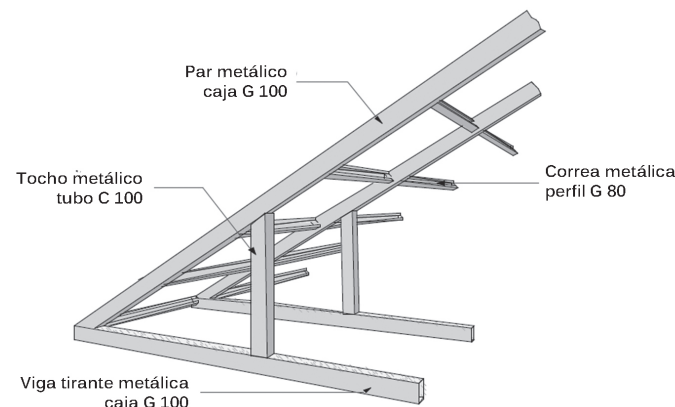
Detalle de los refuerzos de pares mediante tochos de tubo metálico.
